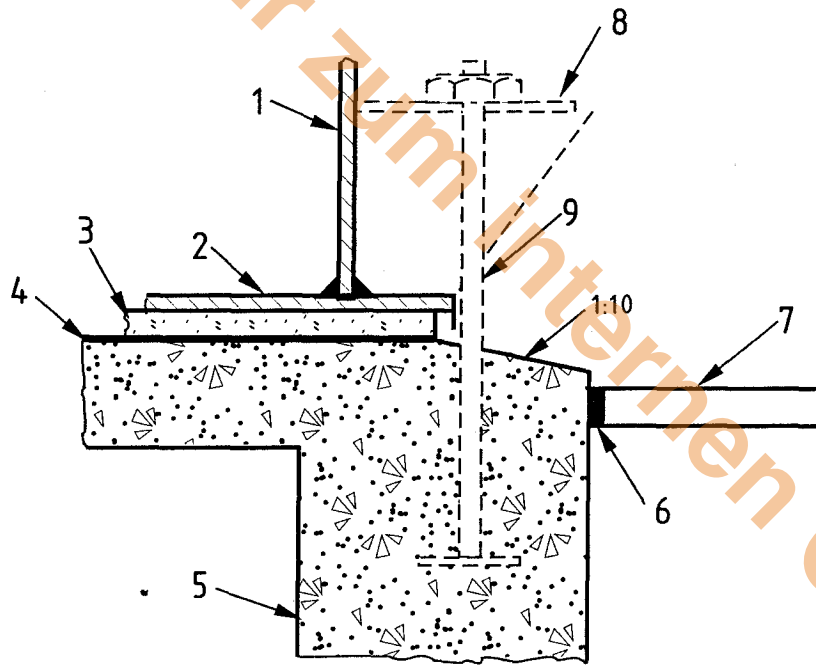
Typische Ausführung eines Plattenfundamentes
